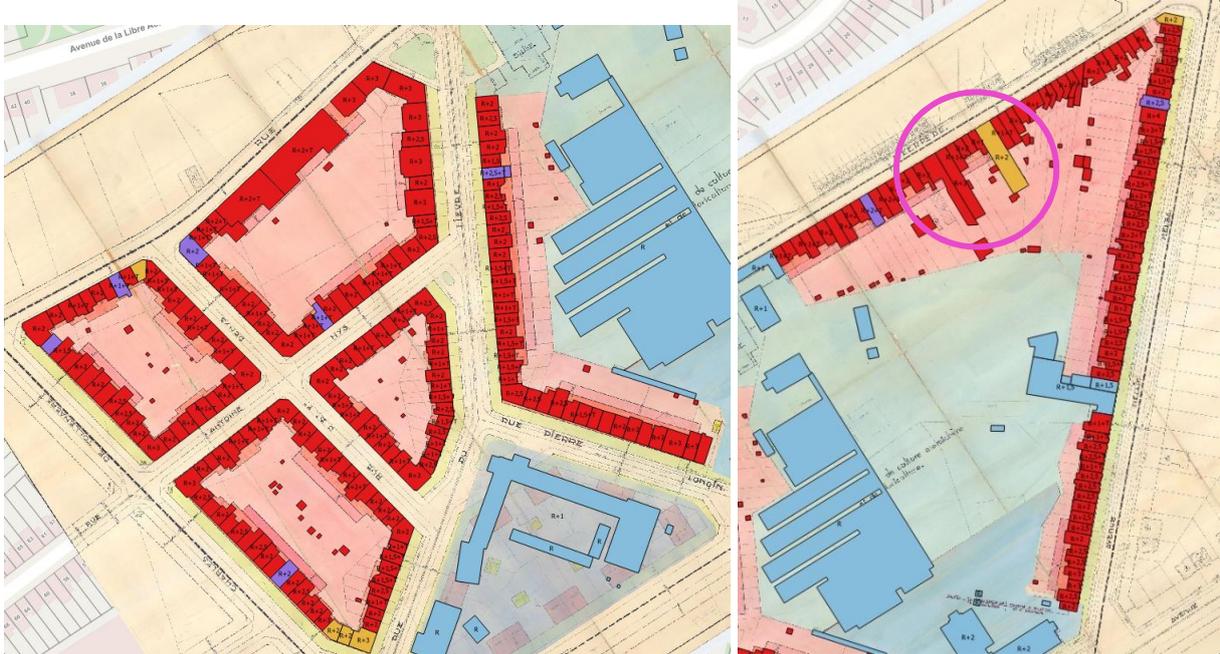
Superposition entre le PPAS et la situation existante de fait (partie ouest du plan et partie est du plan)
